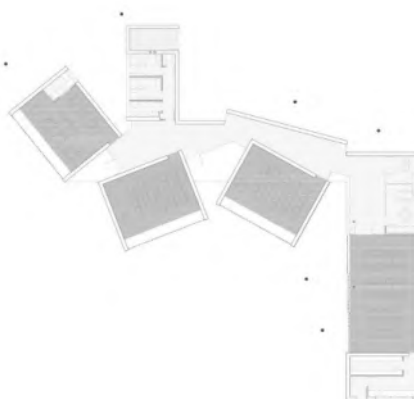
Planta del centro rural, Autor Archdaily, 2010
